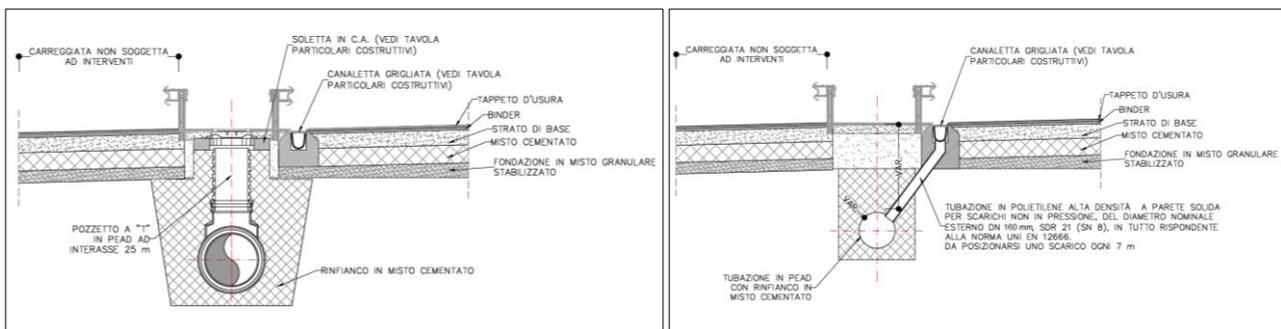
Planimetria e sezione tipo delle modalità di smaltimento delle acque meteoriche in trincea con scarpate
